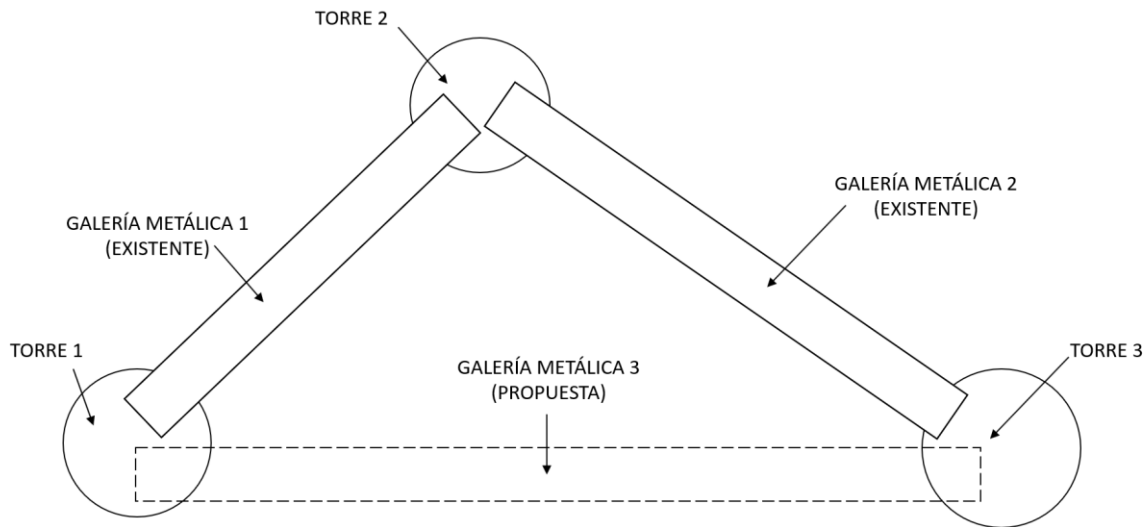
Esquema de la vista de planta del proyecto a tratar.
